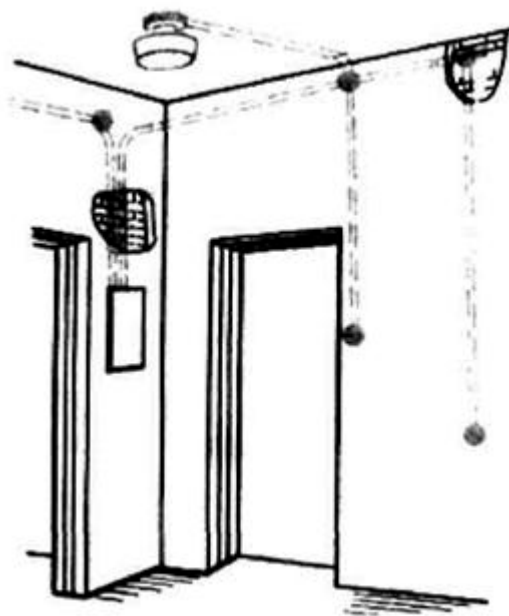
Скрытые электропроводки под слоем мокрой штукатурки
